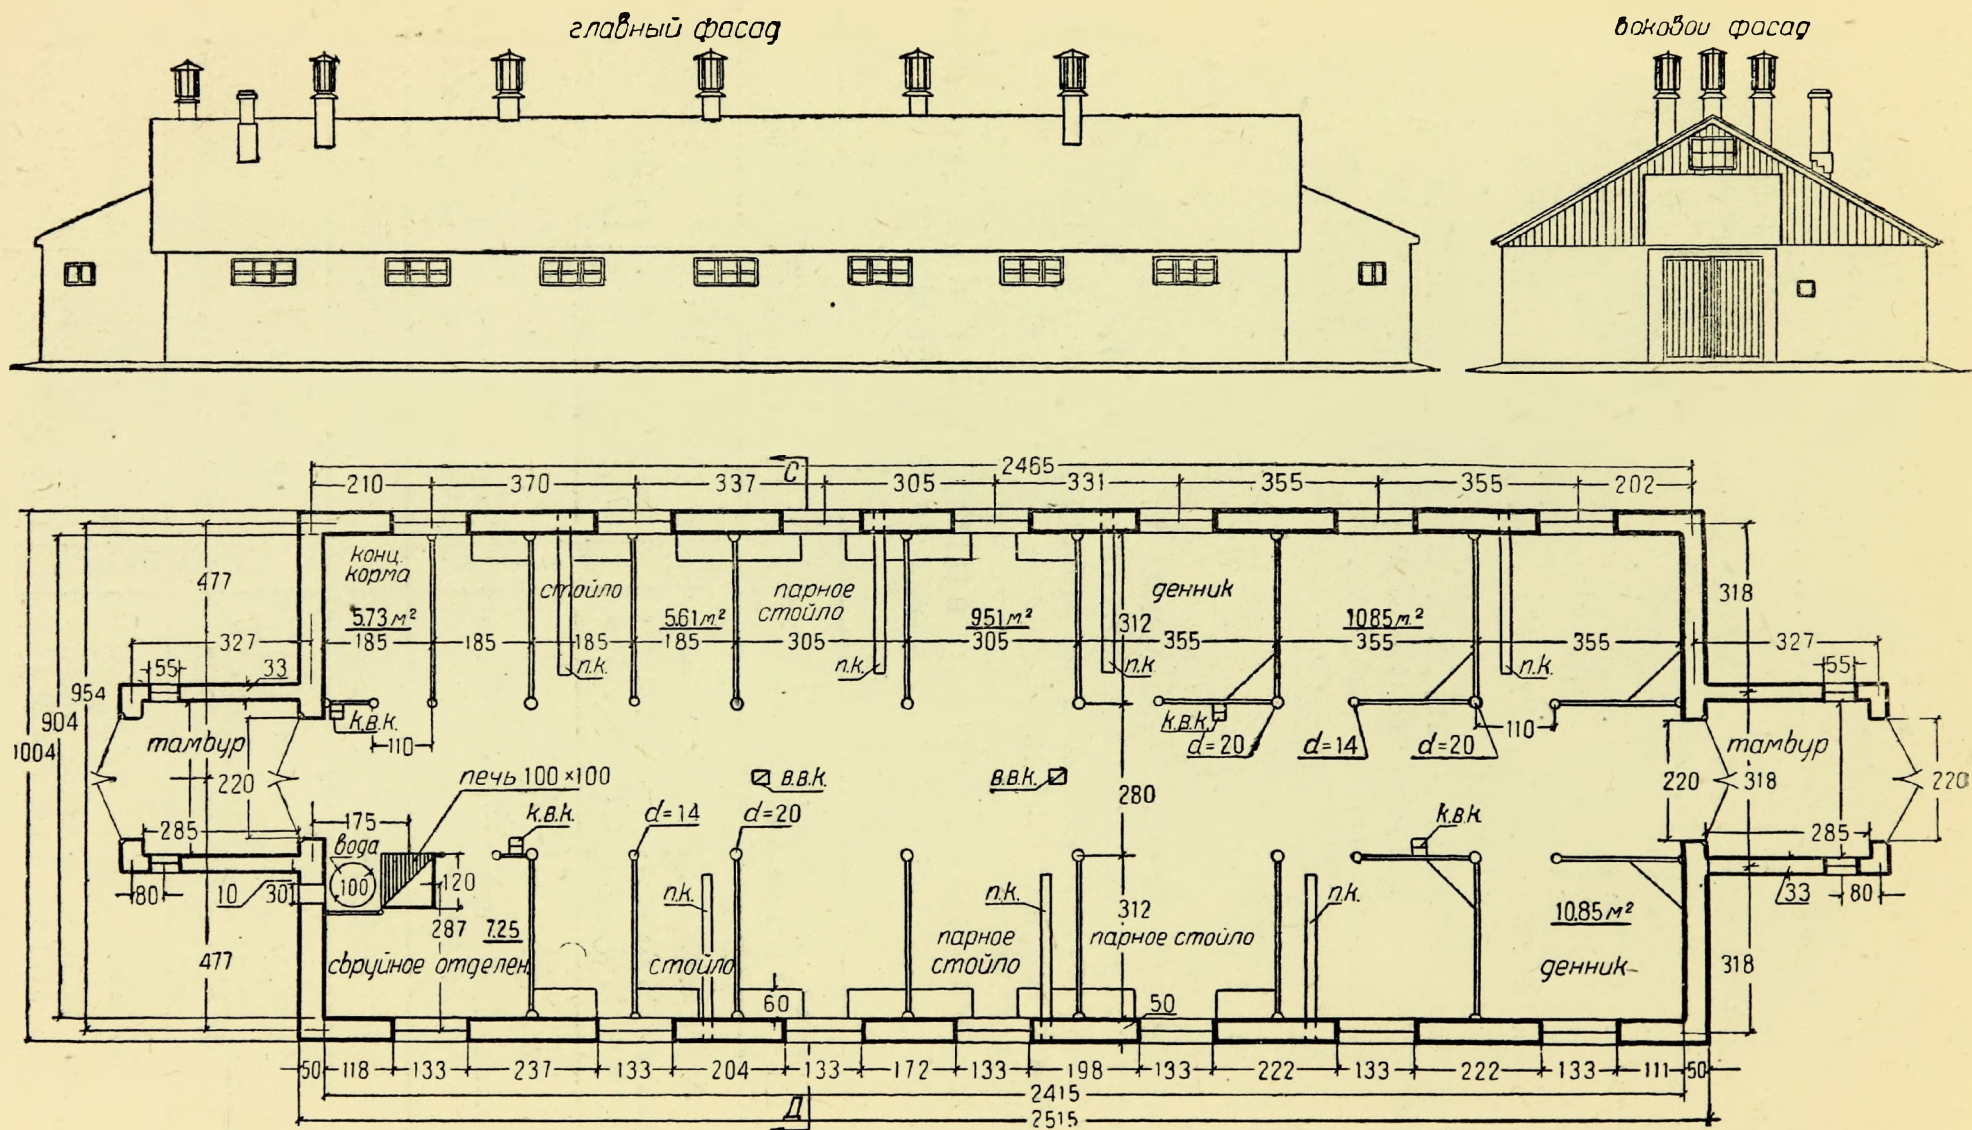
Фасады и план конюшни на 20 рабочих лошадей в 3-й климатической зоне для крупных лошадей (парные стойла).
